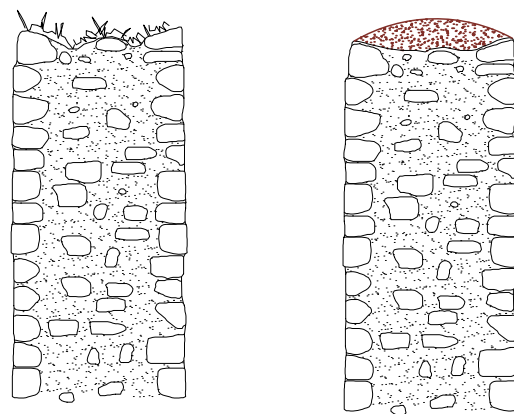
Protezione delle creste murarie con bauletto di malta
